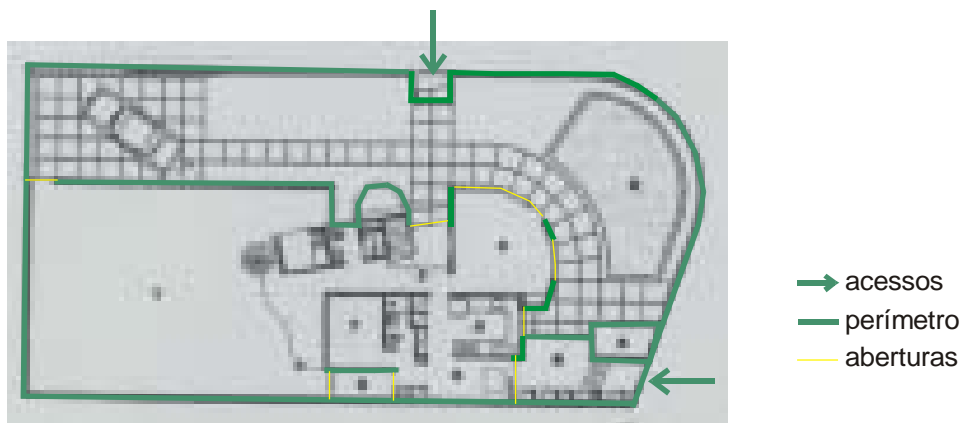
Planta do Primeiro Piso: Acessos e Perímetro
